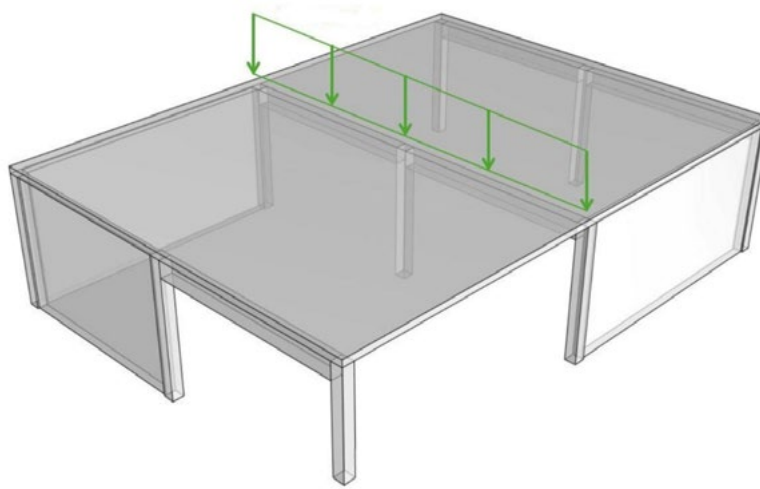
Распределенная нагрузка по линии, моделирующая вес перегородки на покрытие здания
